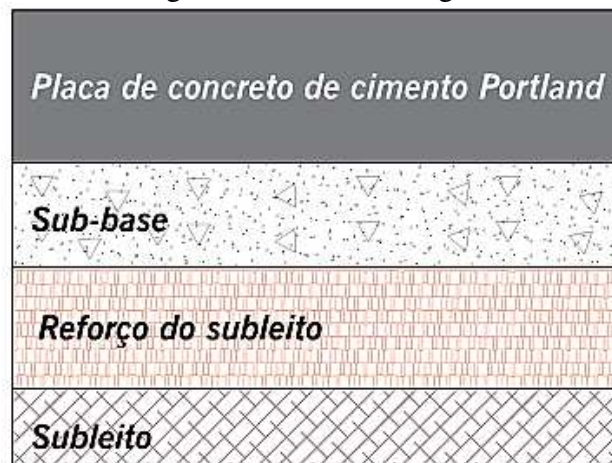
Distribuição de tensões nos pavimentos rígidos
